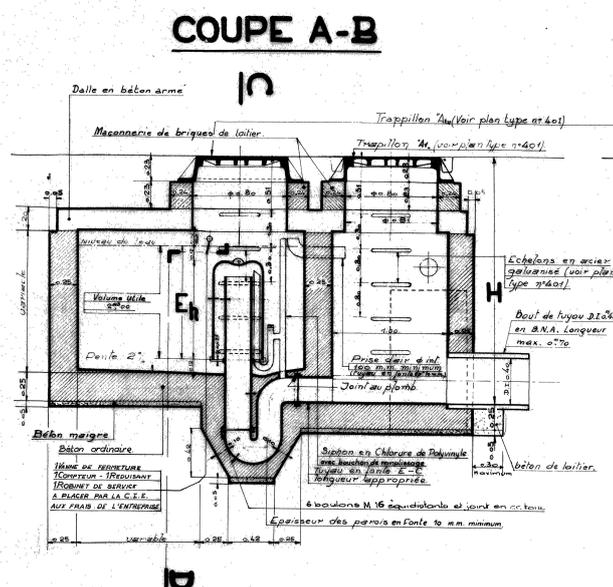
Coupe type d'un bassin laveur (AIDE)
